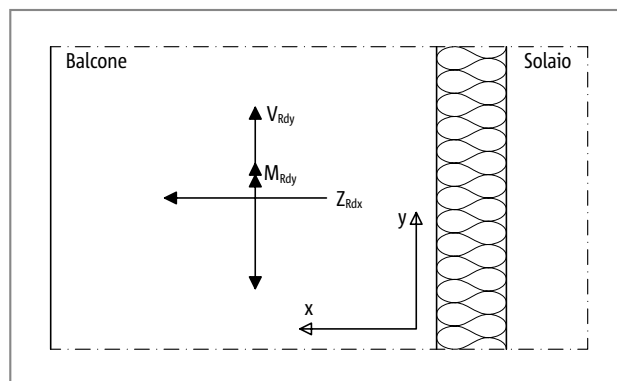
Schöck Isokorb® tipo EQXT: regola dei segni per il calcolo
